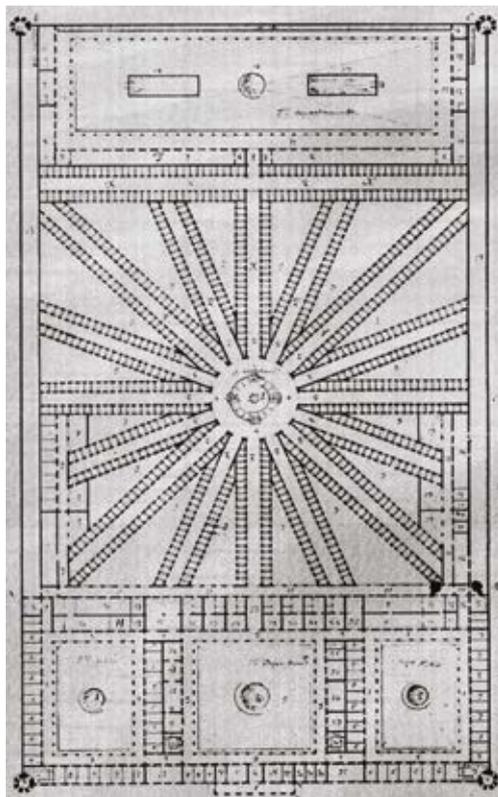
Planta arquitectónica baja de la Penitenciaría de Escobedo (Trujillo, 2011, p. 37).
